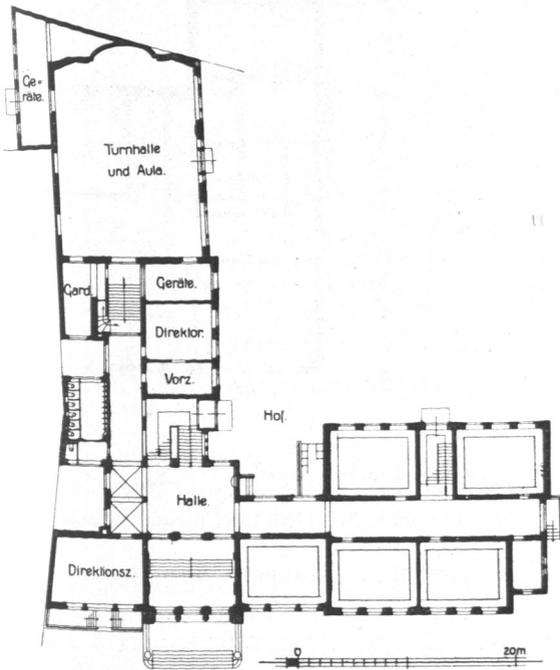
Talmud-Tora-Schule, Grundriß, Erdgeschoss.
